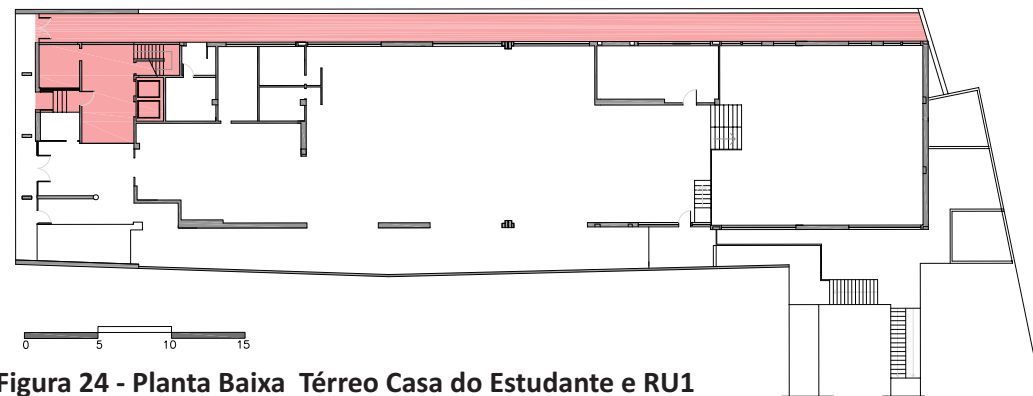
Planta Baixa Térreo Casa do Estudante e RU1
